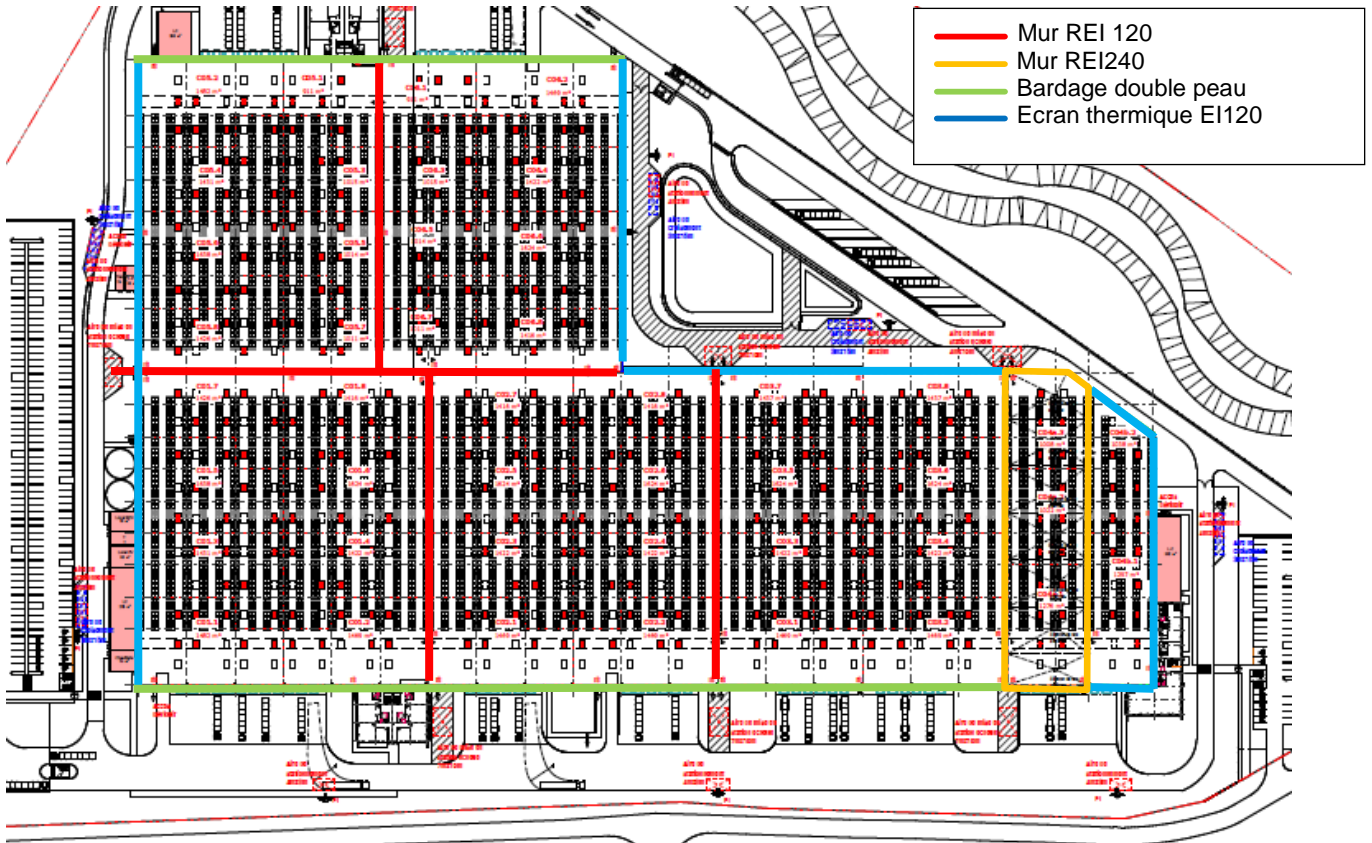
plan schématique du bâtiment WESTEA à Poitiers
